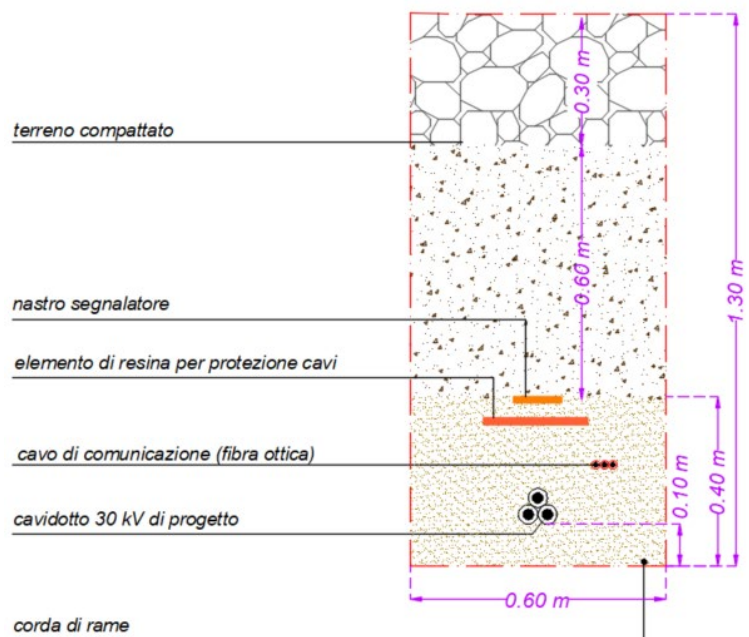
Sezione cavidotto singola terna su misto stabilizzato
